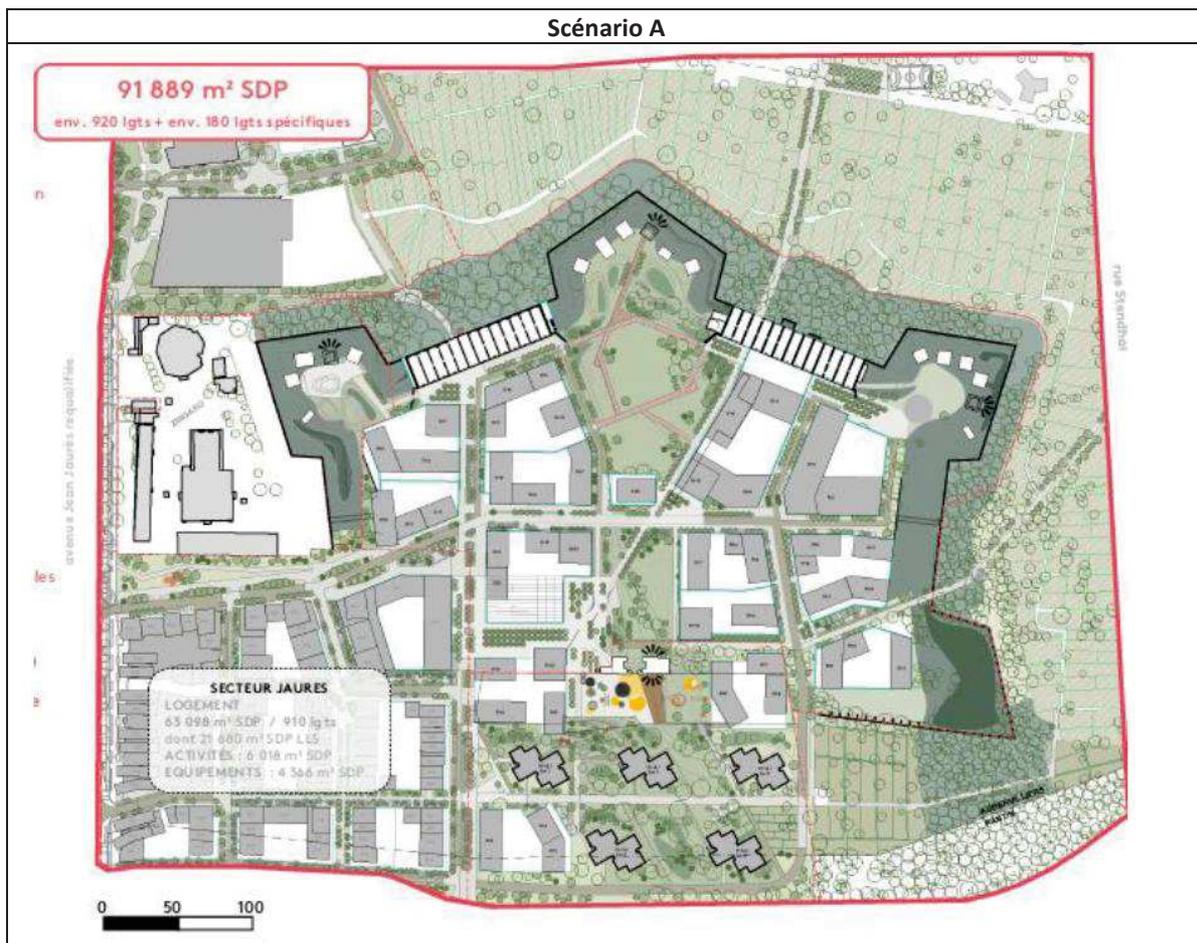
Plan guide juillet 2023 (Groupement CoBe)
